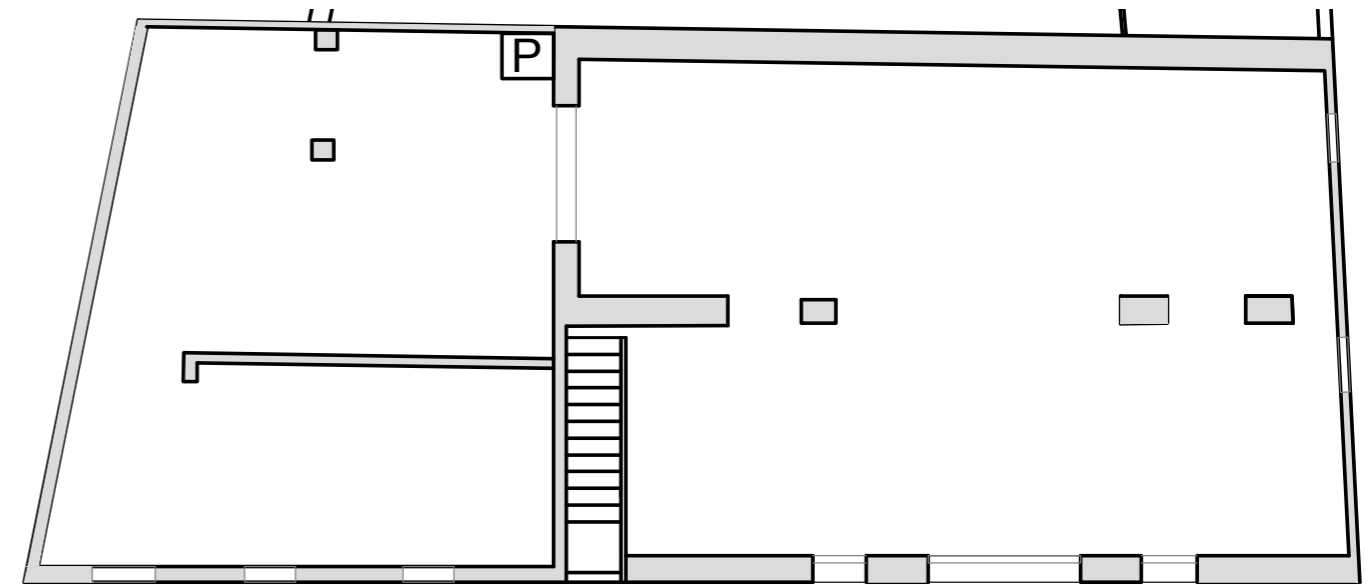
Planta de zona taller - fusteria. Elaboració pròpia.
